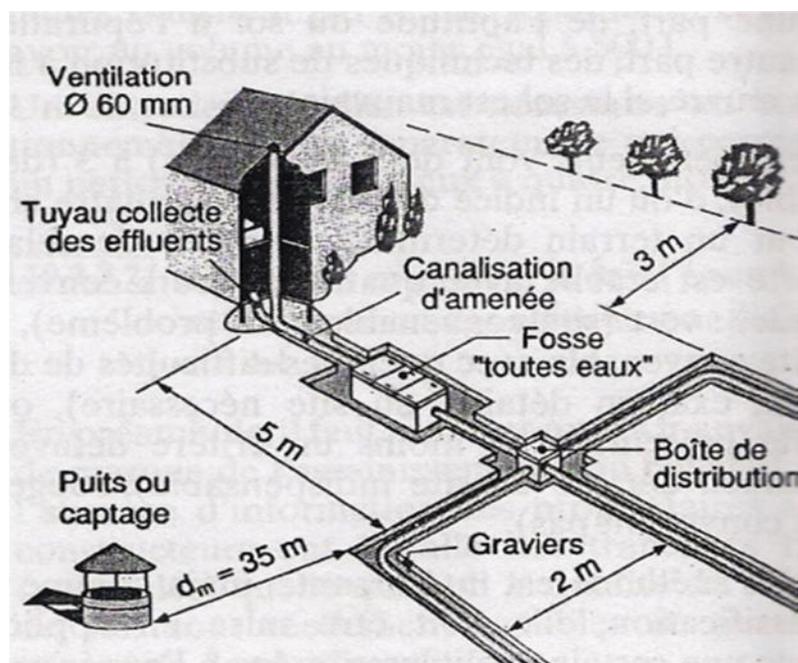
Représentation d'un réseau de tranchées parallèles sur terrain plat et favorable
